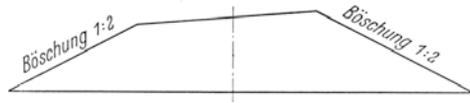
Damms mit starr angewandter „profilgemäßer“ Böschung bei einem Damms in der Kurve.
